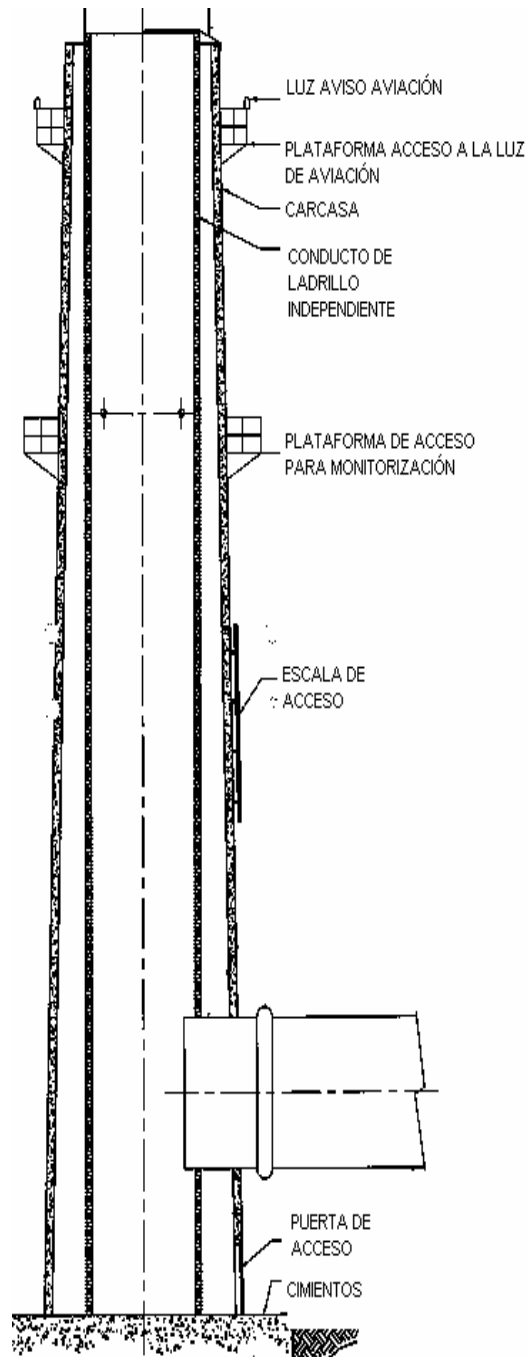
Chimenea de hormigón con conducto de ladrillo independiente, soportado en la base
